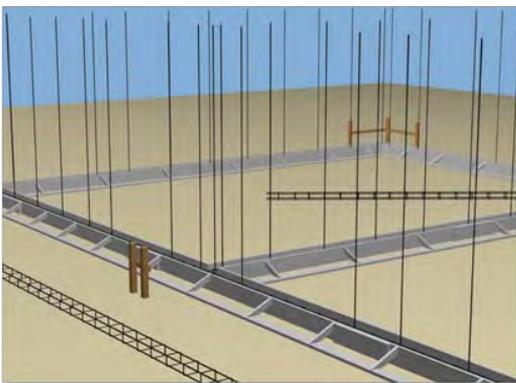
Enfierradura y moldaje de sobrecimiento. Fig.66.- Detalle de la enfierradura y moldaje de sobrecimiento.
